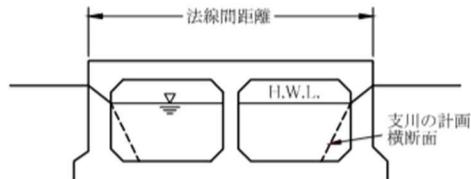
樋門の断面説明図（流下断面積が 1:1.3 以内の場合）
